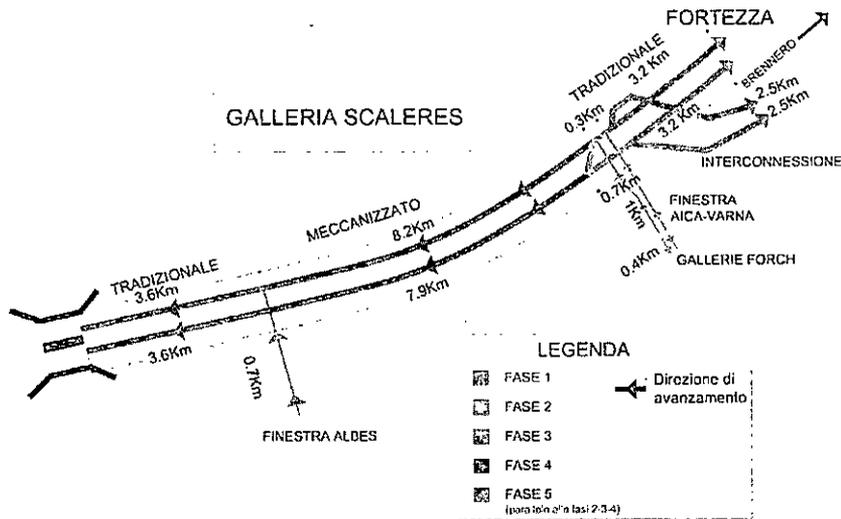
Modalità di scavo Galleria Scaleres Lotto 1 Fortezza – Ponte Gardena
